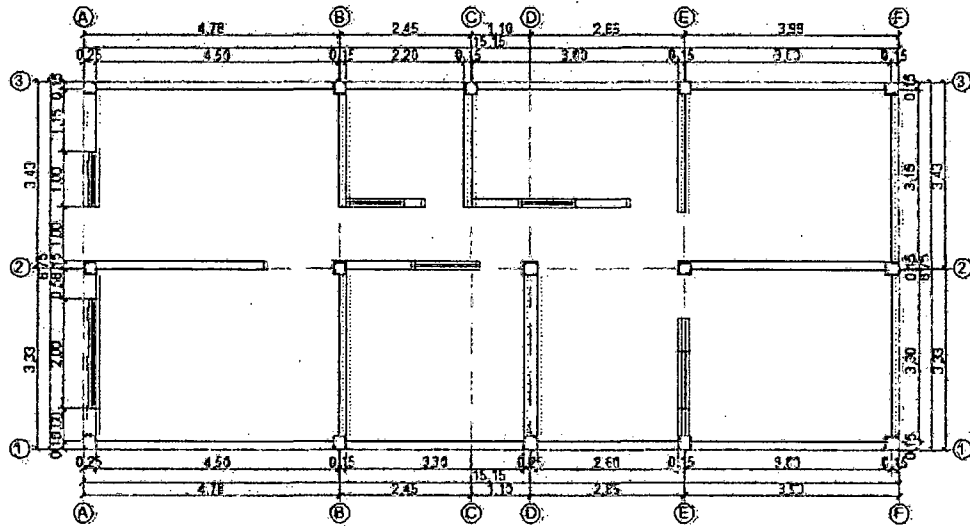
Plano de arquitectura de la planta típica de la Vivienda TV3.
